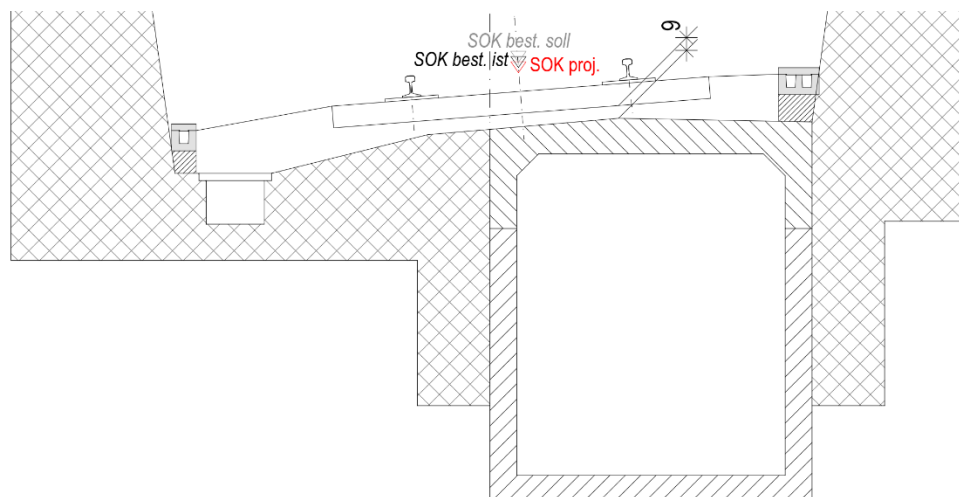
Querschnitt A-A durch Fabrikkanal (Bestandesplan angepasst nach Aufnahmen vom April 2019)
